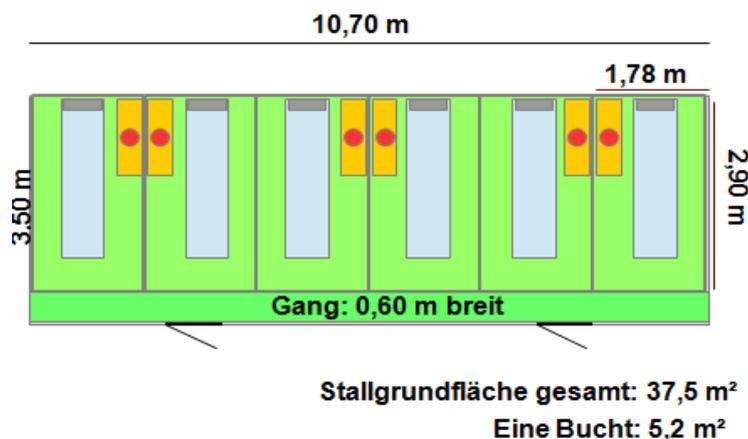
Abteilgrundriss vor Umsetzung einer Gruppenhaltung ferkelführender Sauen im Betrieb D
